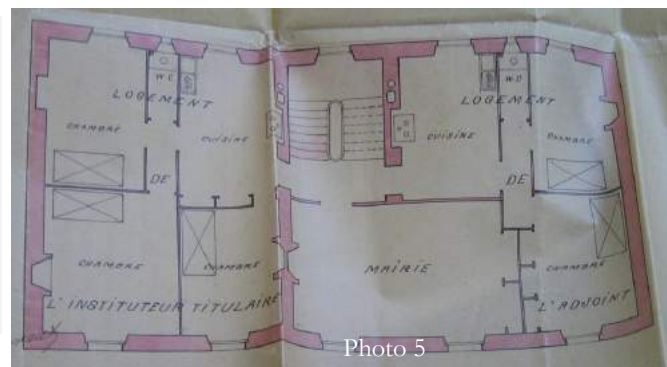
Façade de la mairie-école de Arthur Bertin - Photo 5 : plan du 1er étage avec les logements et la mairie // Collection Département de la Savoie, Archives départementales, 2O 2872
